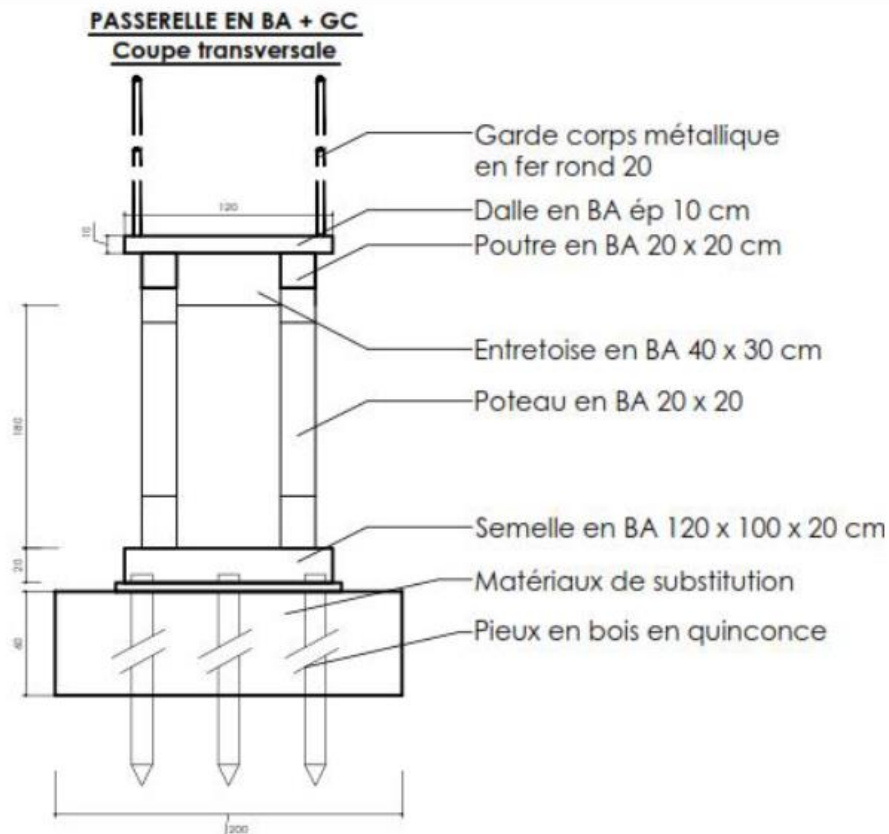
Schéma de principe des installations proposées pour la réhabilitation des passerelles.
